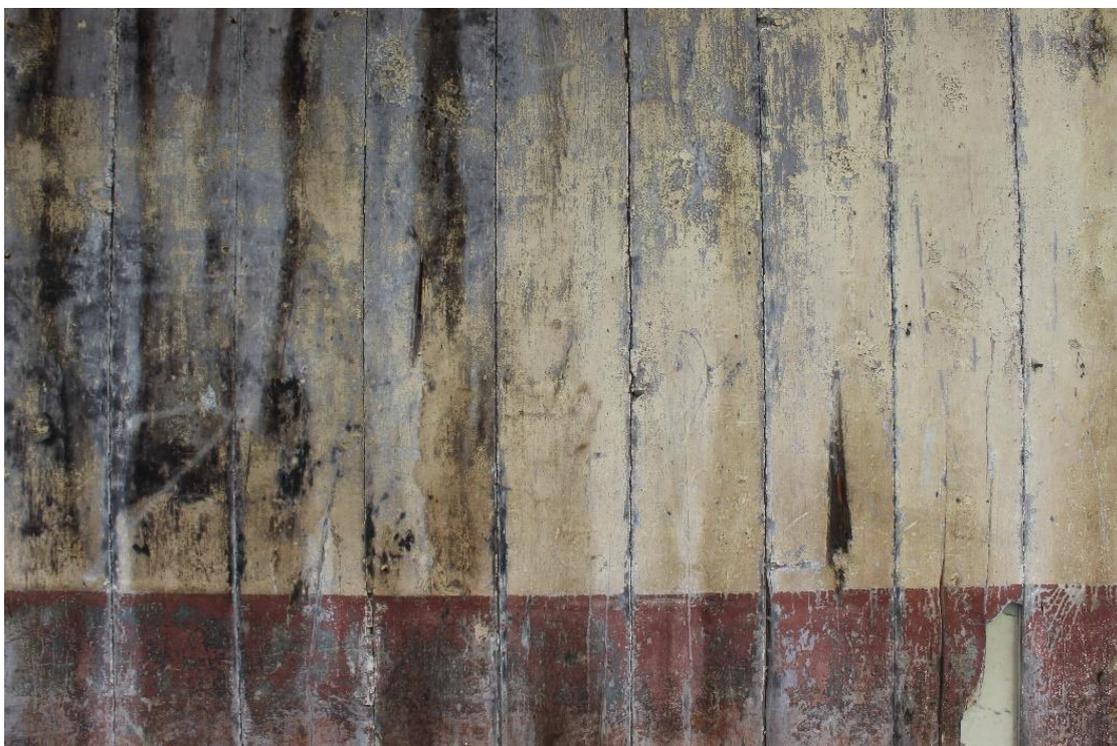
Muro Fachada sur. Fuente: Elaboración Propia.
